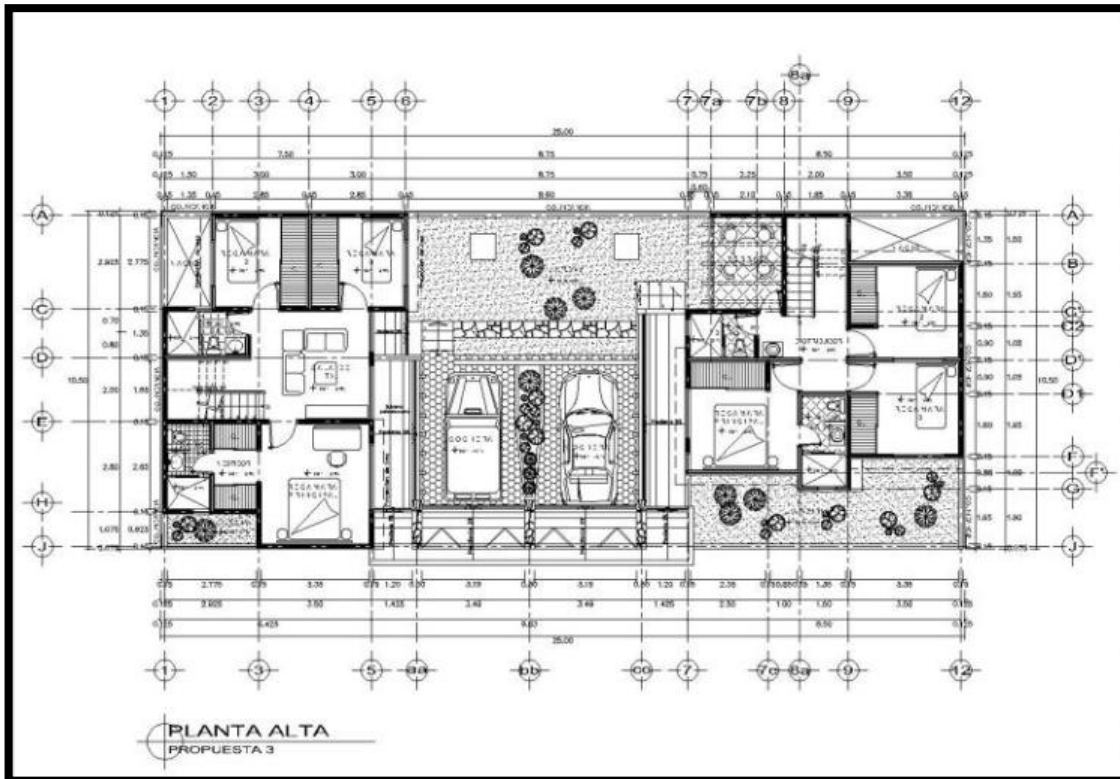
Ejemplo de un plano arquitectónico. Fuente: (Imágenes Google. 2017.)
